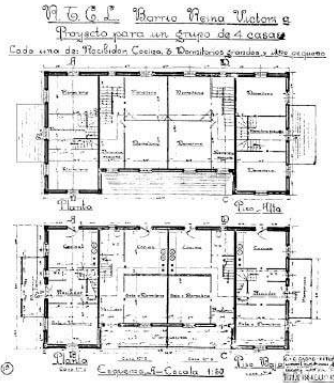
Plantas de casas de dos alturas en Huelva (Archivo de los autores).
